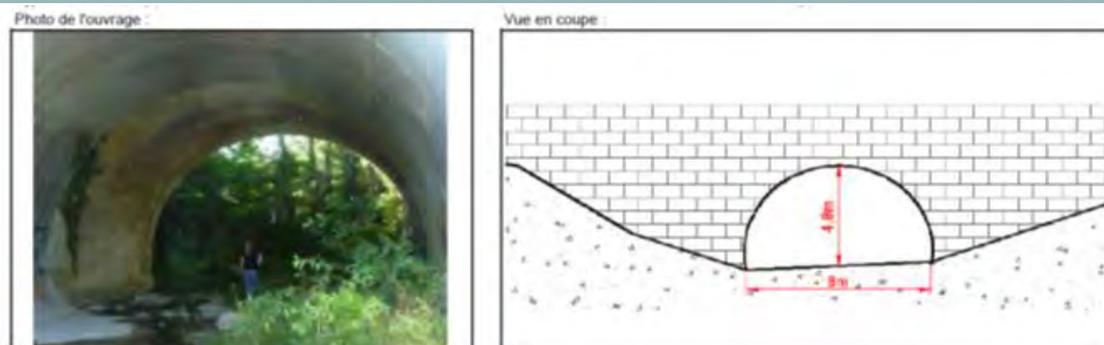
OUVRAGE ET COUPE DE L'OUVRAGE SOUS LA RD26E7
